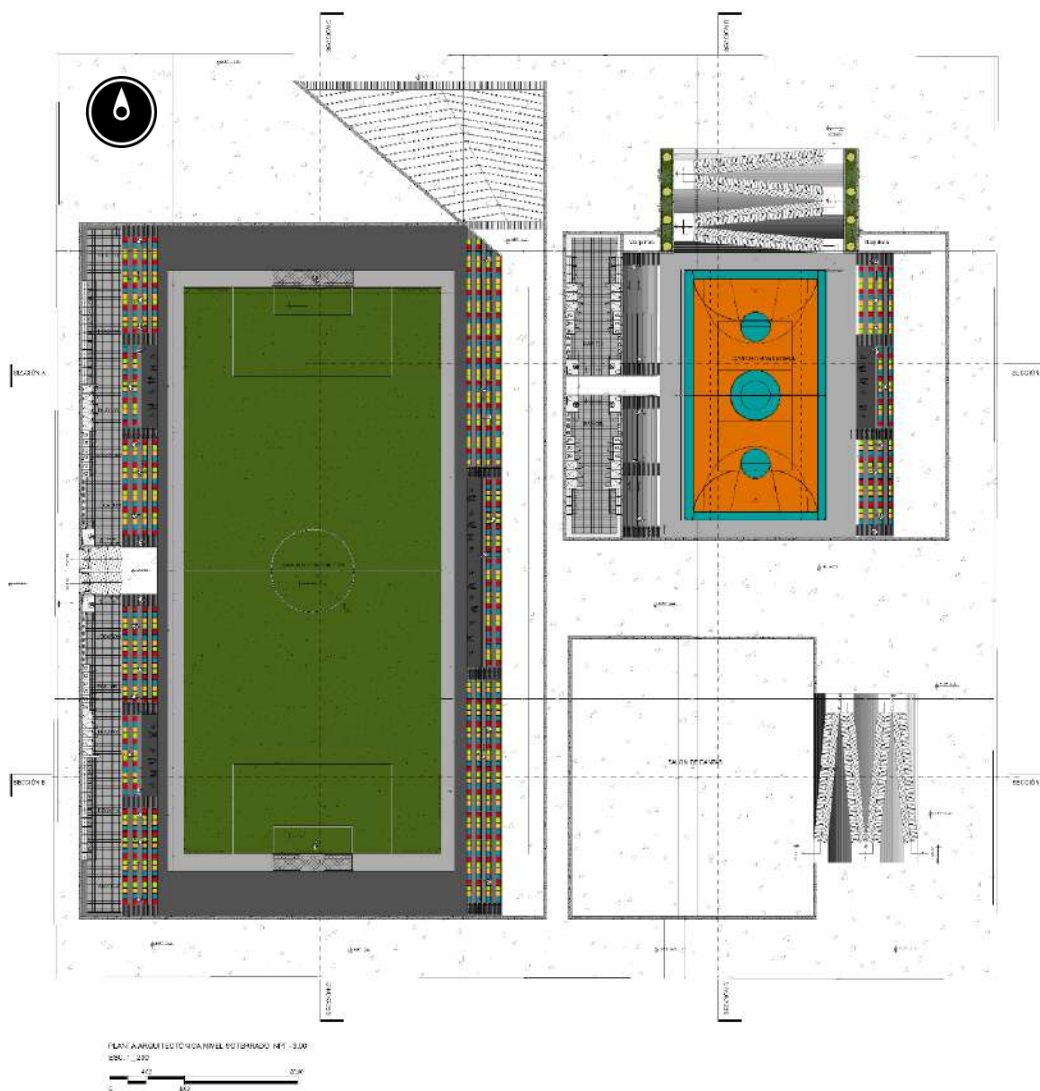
Planta arquitectónica nivel -3.00. Fuente: Elaboración propia 2021.
